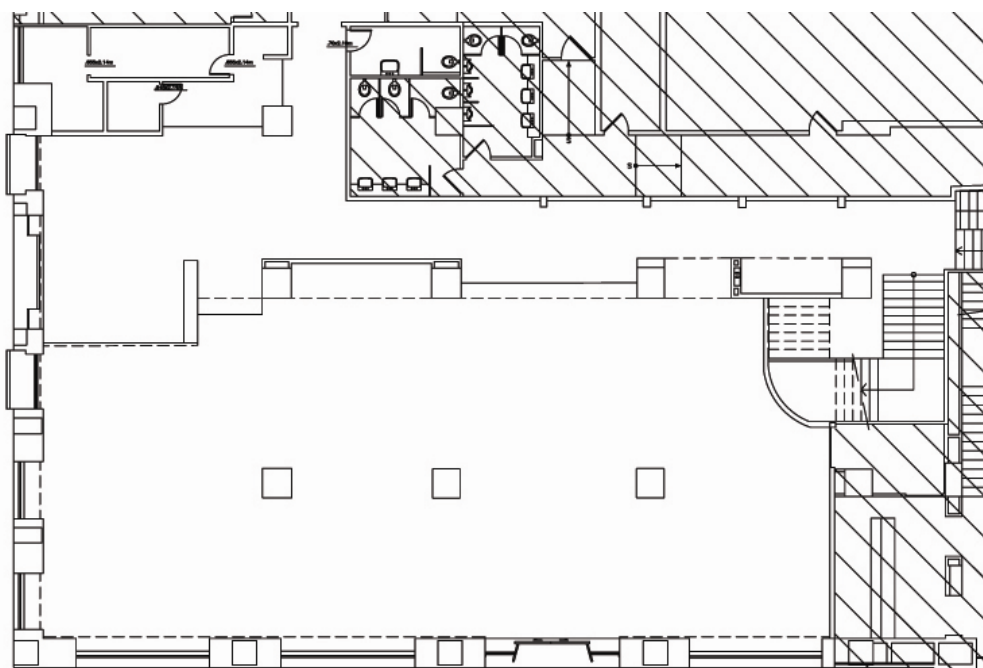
Planta do novo espaço (dimensões aproximadas: 25,90 x 11,10m, com 3 colunas em estruturais dentro do ambiente).
